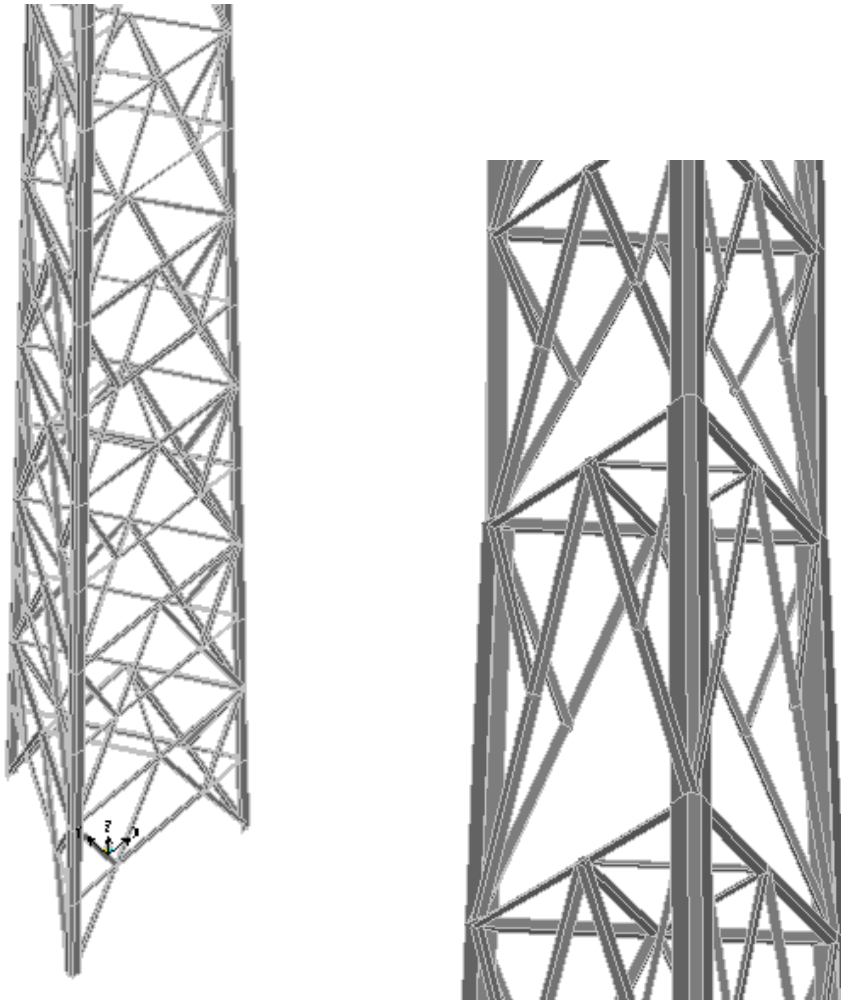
Torre de 40m con secciones transversales de perfiles en 3d
